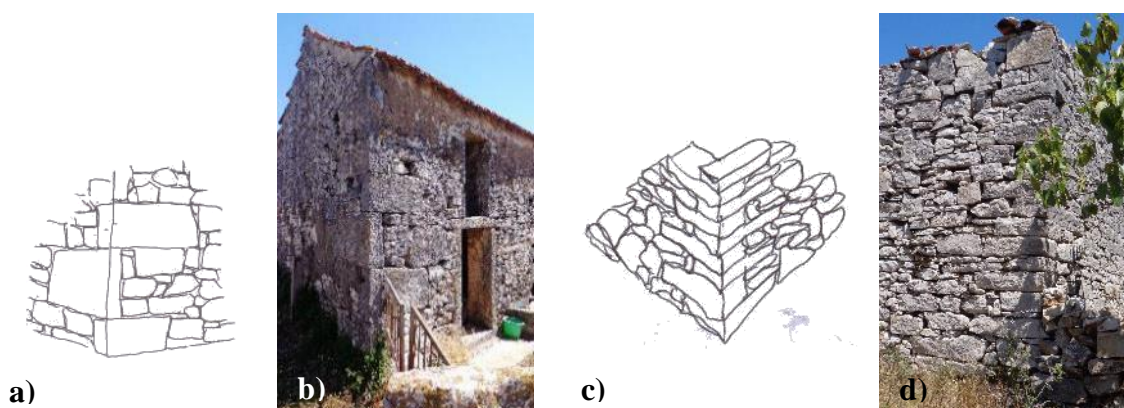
a) e b) Colocação das pedras dos cunhais ao cutelo; c) e d) Colocação das pedras do cunhal à meia vez
